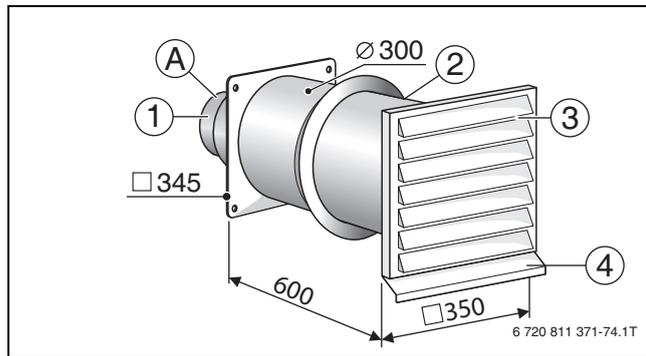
Dimensioni della bocchetta a parete WG 160/1 (quote in mm)
